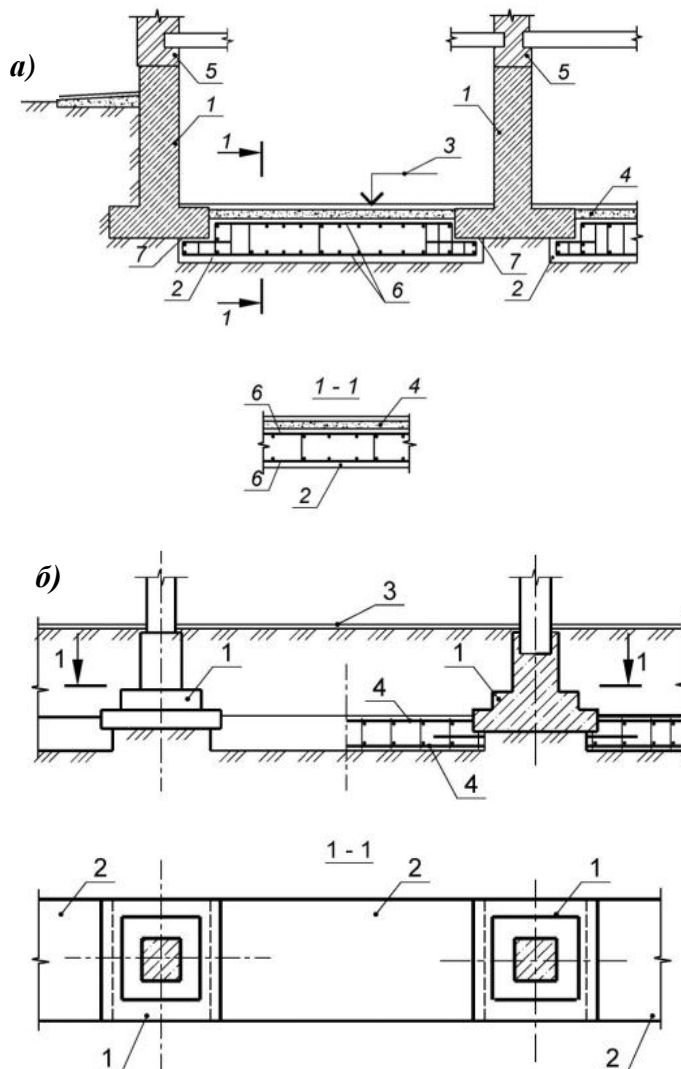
Увеличение несущей способности фундамента путем изменения конструктивной схемы передачи нагрузки на основание: а) переустройство ленточного фундамента в плитный; 1 – усиливаемый фундамент; 2- устраиваемая железобетонная плита усиления фундамент (сплошная или прерывистая); 3-отметка поверхности пола подвала; 4 – уплотненный крупный песок; 5 – кирпичная
